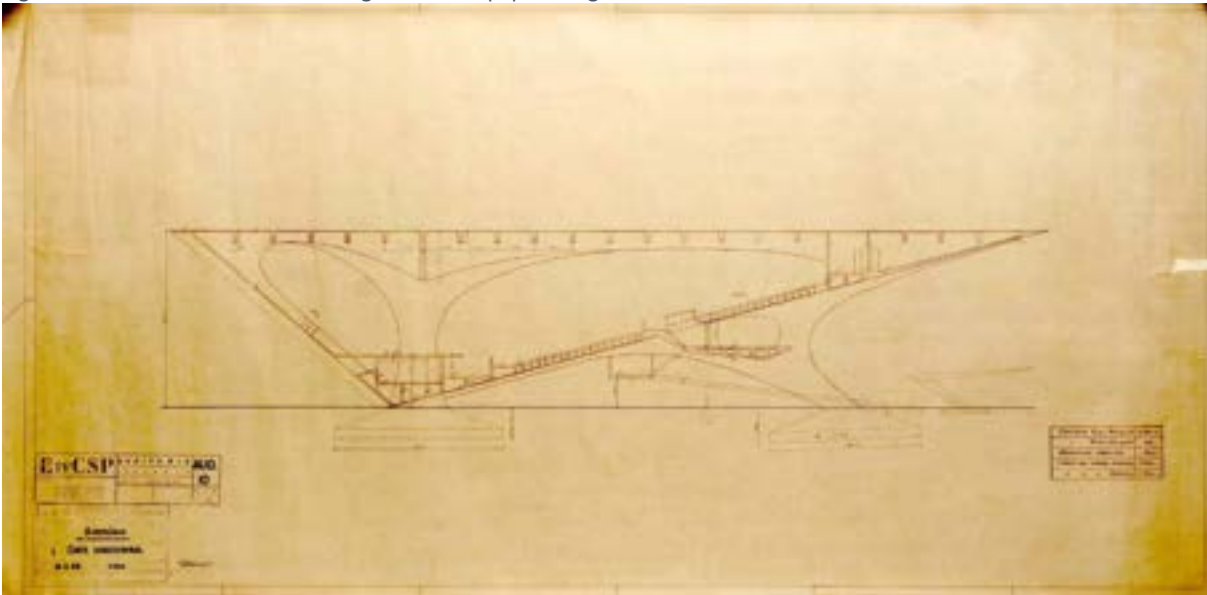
Corte estrutural Longitudinal – desenho nosso.
